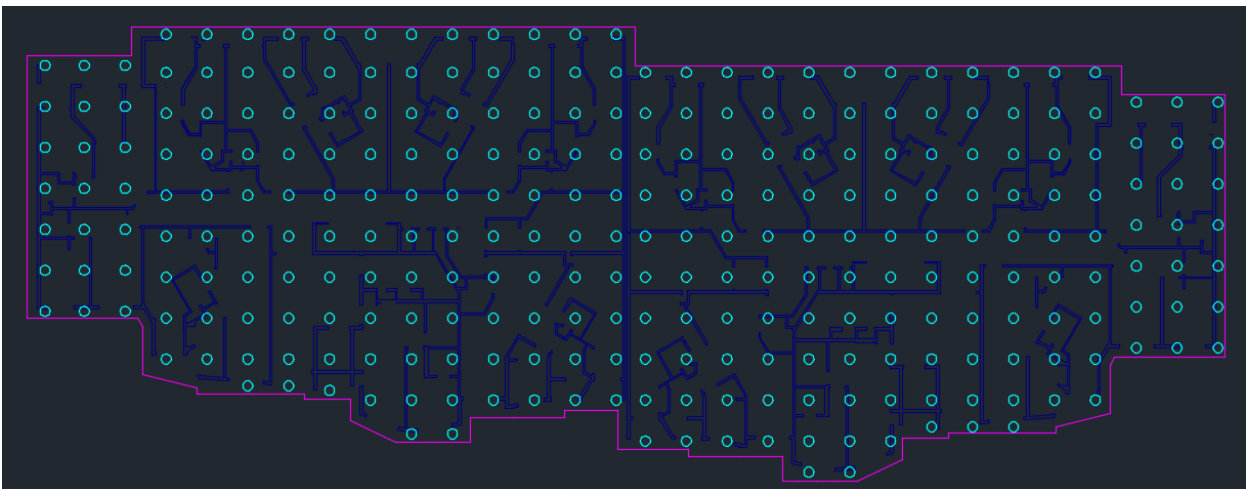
Modulación en planta para determinar la cantidad de pilas de gravas compactadas, Adaptado de “Elaboración propia”, por Obregón y Plascencia, 2018
